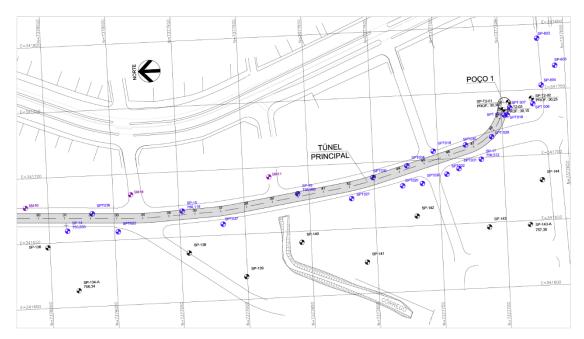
Planta geral de localização do túnel – parte 1. (Fonte: Projeto Executivo GeoCompany)
